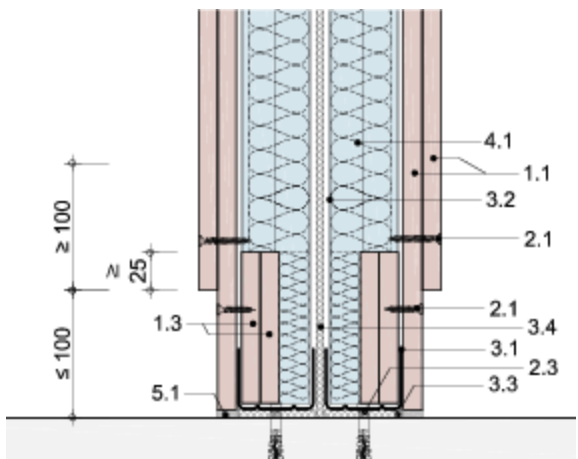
Fußpunkt mit Sockelhinterlegung Einfachständerwand
